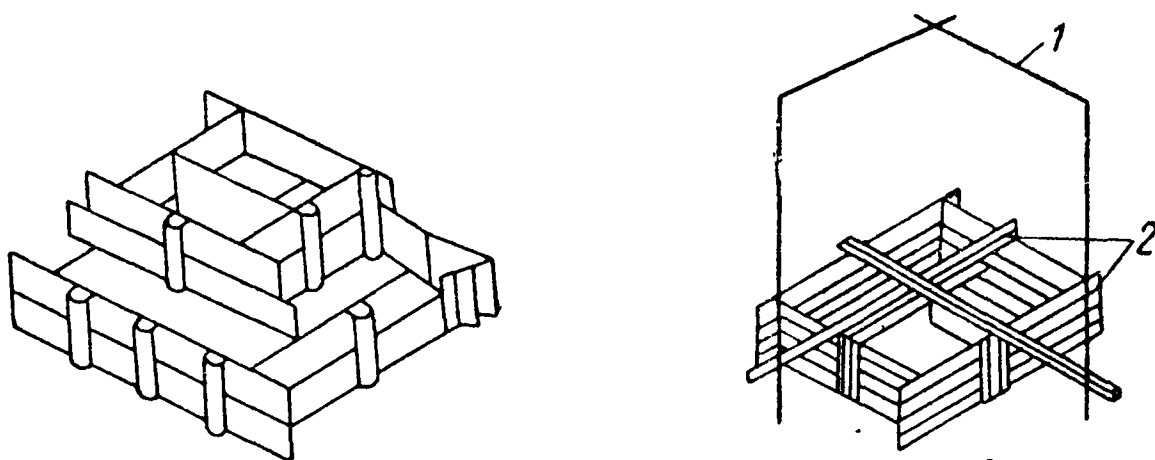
Схема установки опалубки отдельного монолитного фундамента
